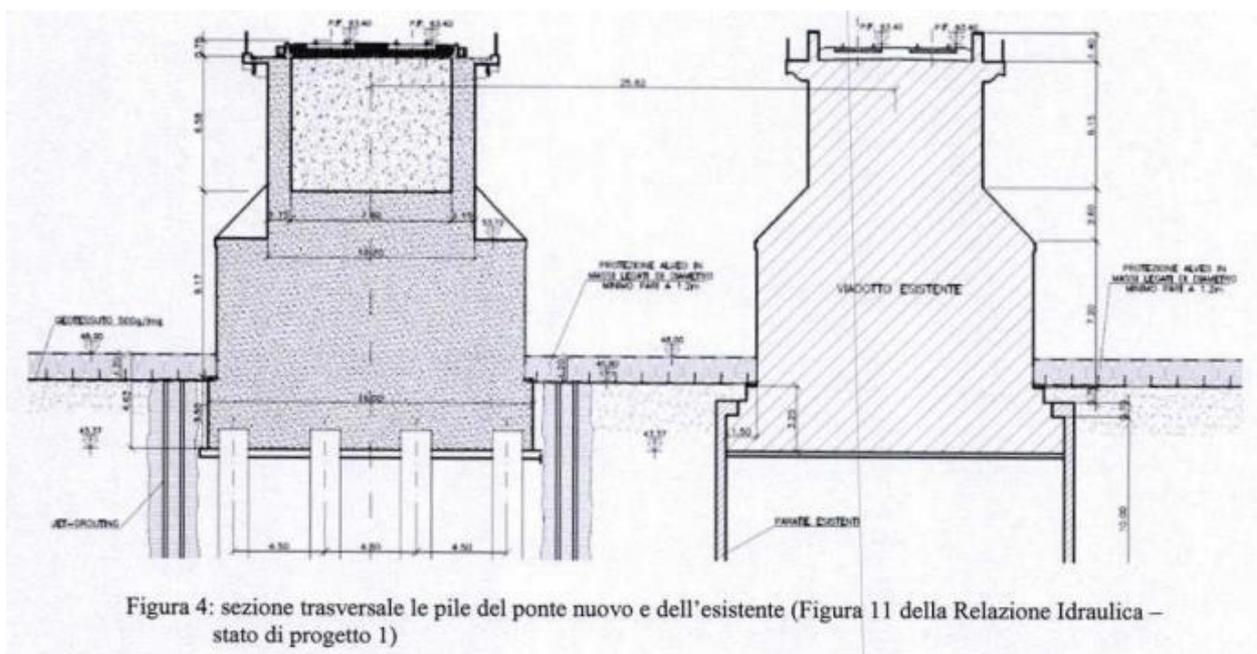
sezione trasversale le pile del ponte nuovo e dell'esistente (Figura 11 della Relazione Idraulica – stato di progetto 1)
